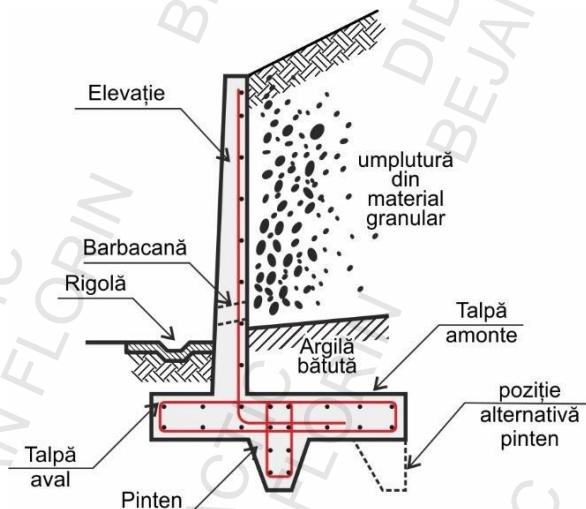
Elementele componente ale unui zid de sprijin din beton armat
